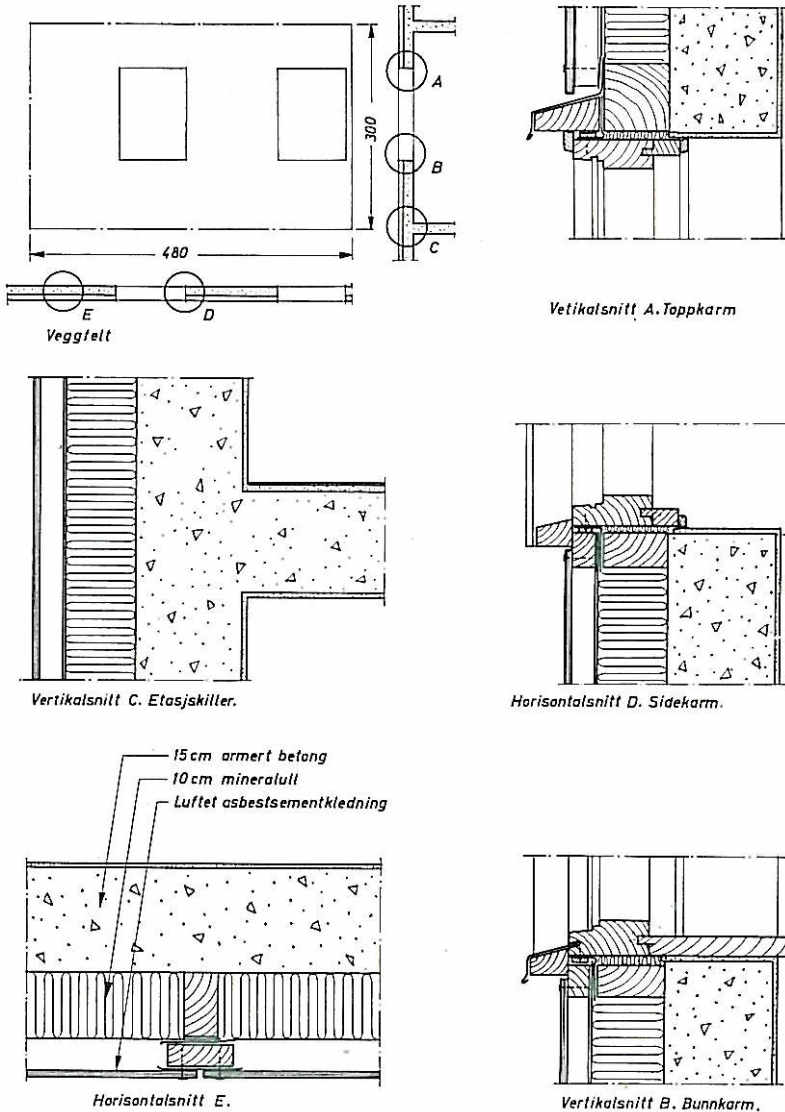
15 cm armert betong isolert utvendig med mineralull. Betongveggen er isolert med 10 cm mineralull som settes opp i to lag mellom 2" x 4" spikerslag skutt fast til betongen og mellom disse kryssende 2" x 4" fastspikret til de fastskutte spikerslag. Utenpå følger ett lag forhudningspapp med klemte skjøter, luftrom og asbestsementplater. • Concrete wall with exterior mineral wool insulation. The reinforced concrete, 15 cm thick, is insulated with two layers of mineral wool, 10 cm in total thickness, placed between 2 in. x 4 in. studs, which are attached edgewise to the concrete, and with 2 in. x 4 in. uprights nailed broadwise to the studs. Furthermore, this wall structure comprises a layer of building paper with clamped joints, an air space, and asbestos cement boards.
